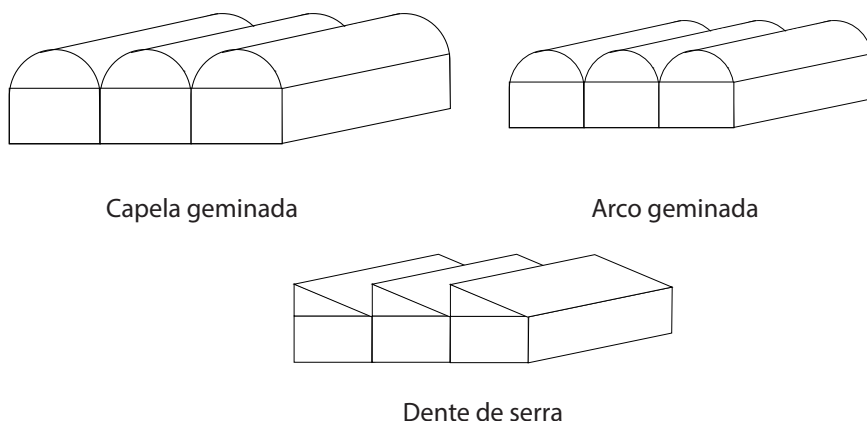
Modelos de estufas múltiplas ou geminadas (Fonte: ilustração dos autores).
